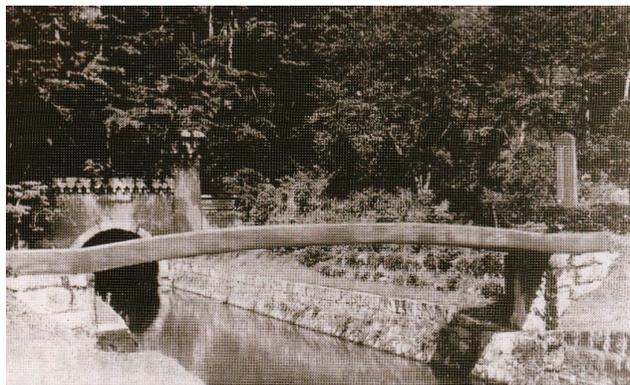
琵琶湖疎水に架かるわが国最初の鉄筋コンクリート橋
